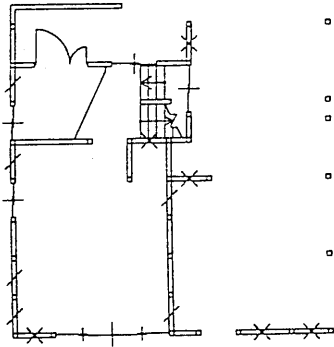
解析対象建築物平面図 (No.7, No.8)
